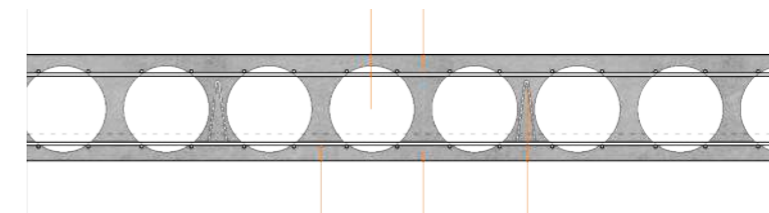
Losa Bubbledeck detalle Fuente: elaboración propia
